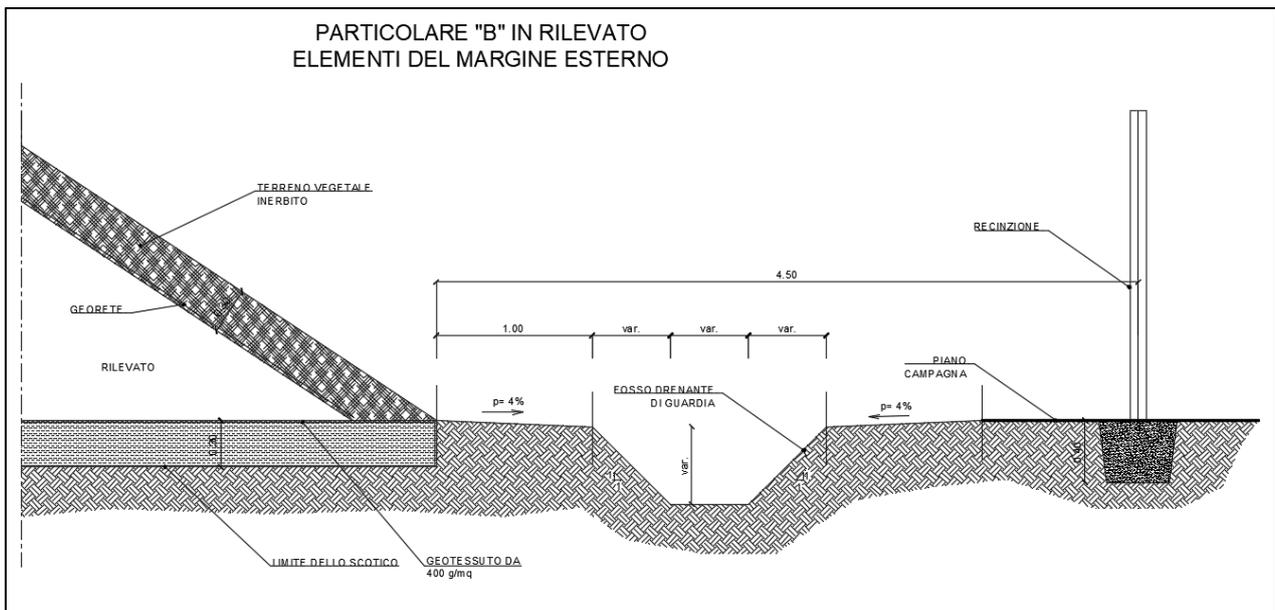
Sistema di scarico in rilevato – fosso al piede rilevato
